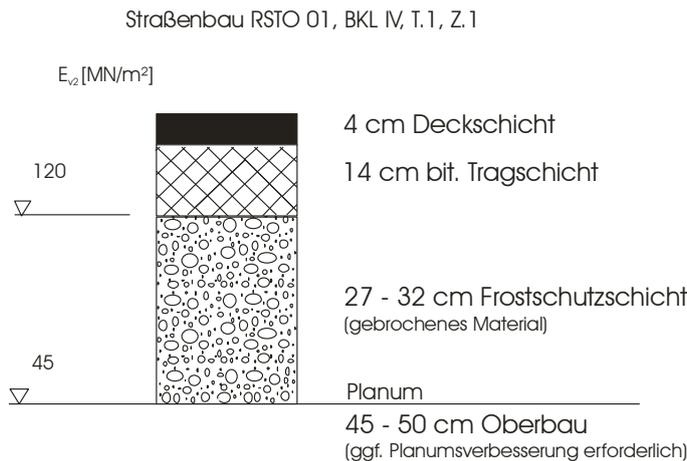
Beispiel einer Bauweise mit Asphaltdecke für Bauklasse IV gemäß RStO 01
